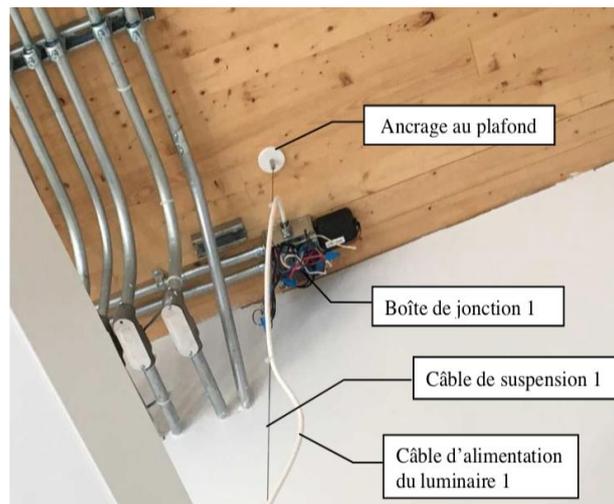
Ancrage et câble métallique de suspension du luminaire 1
